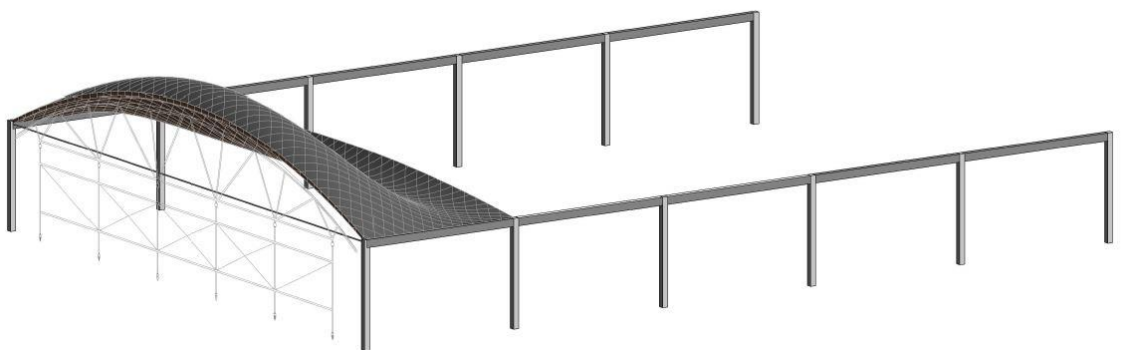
Proceso constructivo Fase 7 Fuente: Elaboración propia
